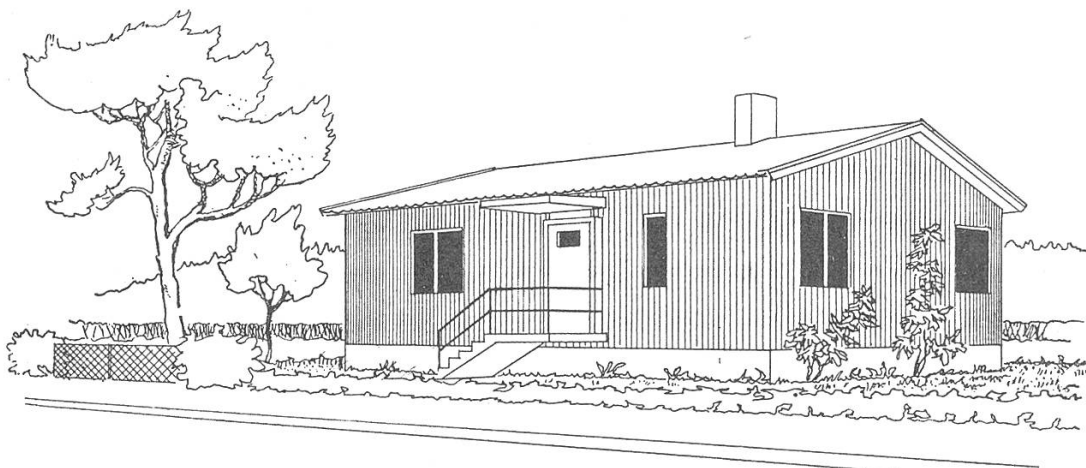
Grösserer Typ eines eingeschossigen Kleinhauses, gedacht für kinderreiche Familien. Das Kellergeschoss enthält zwei disponible Räume, von denen einer als Werkstatt, der andere als Garage eingerichtet werden kann. Baukosten 1939: (hoher Bauindex) 14 500 SKr. (1Ster ~ 1SFr.)
